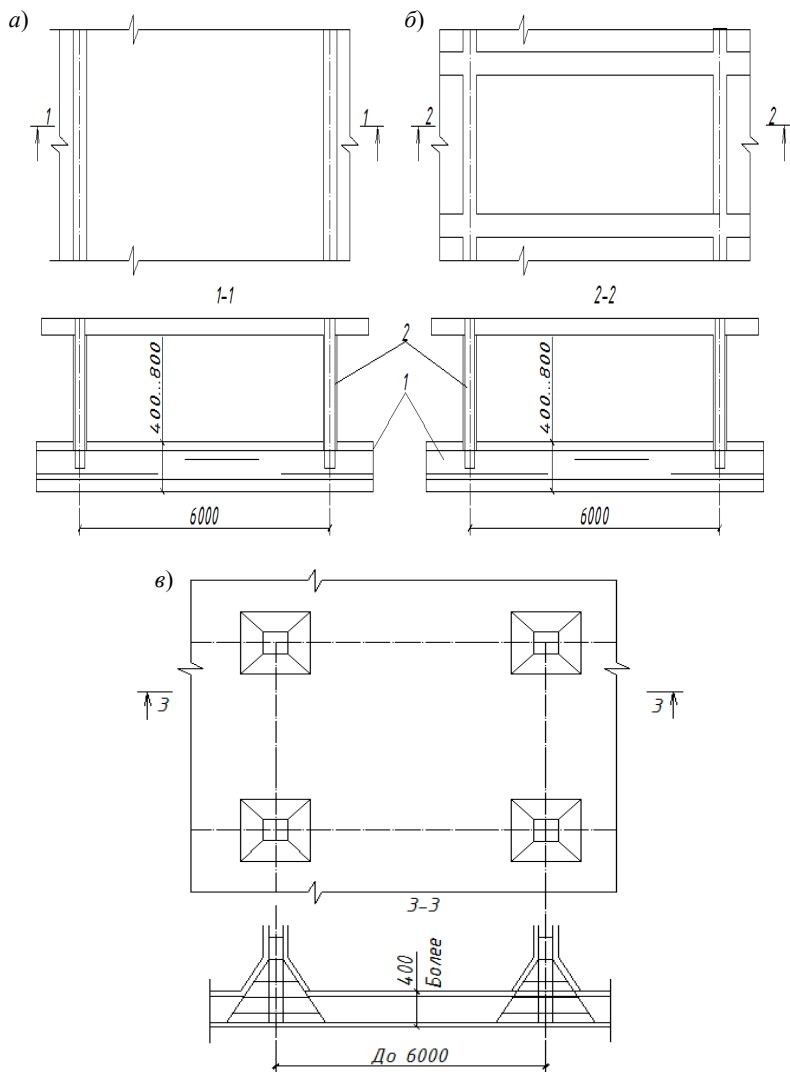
Армирование фундаментов и эффективные типы сплошных фундаментов:
